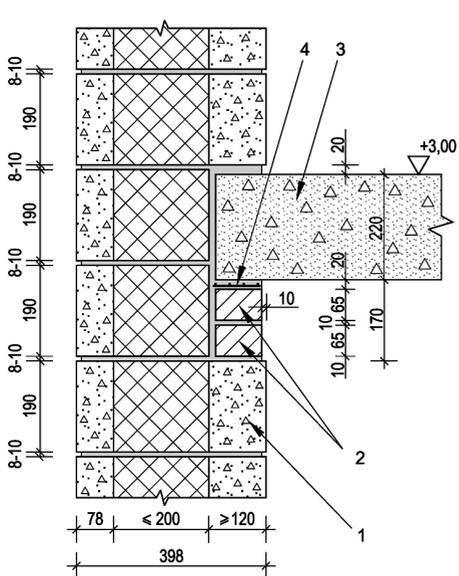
Кладка наружных стен однорядной системы перевязки из трехслойных блоков
